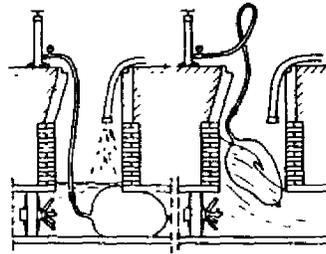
16: Tapa portátil para alcantarillas (LAUTRICH)
